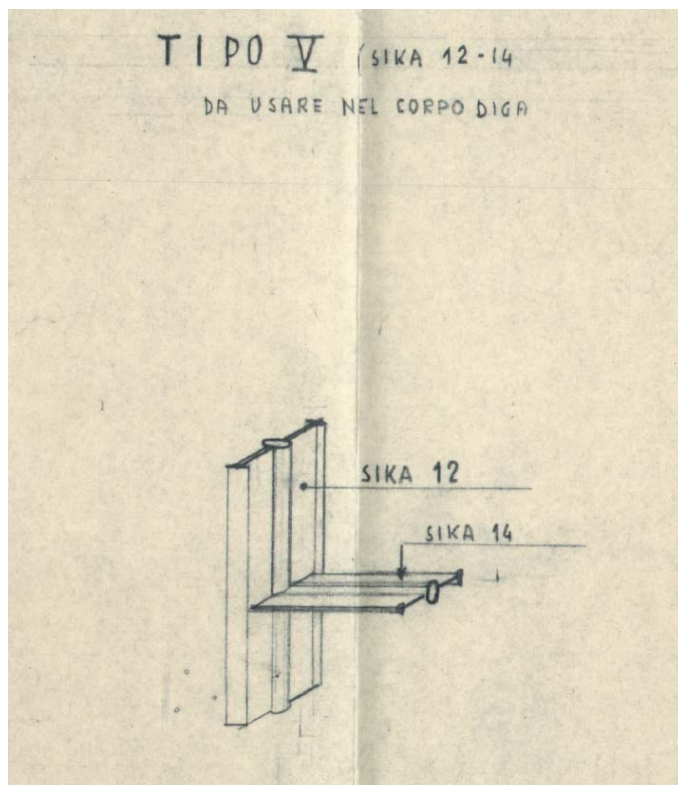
Particolare del water-stop Sika utilizzato nella diga (estratto dalla tavola n.25 allegata al collaudo).
